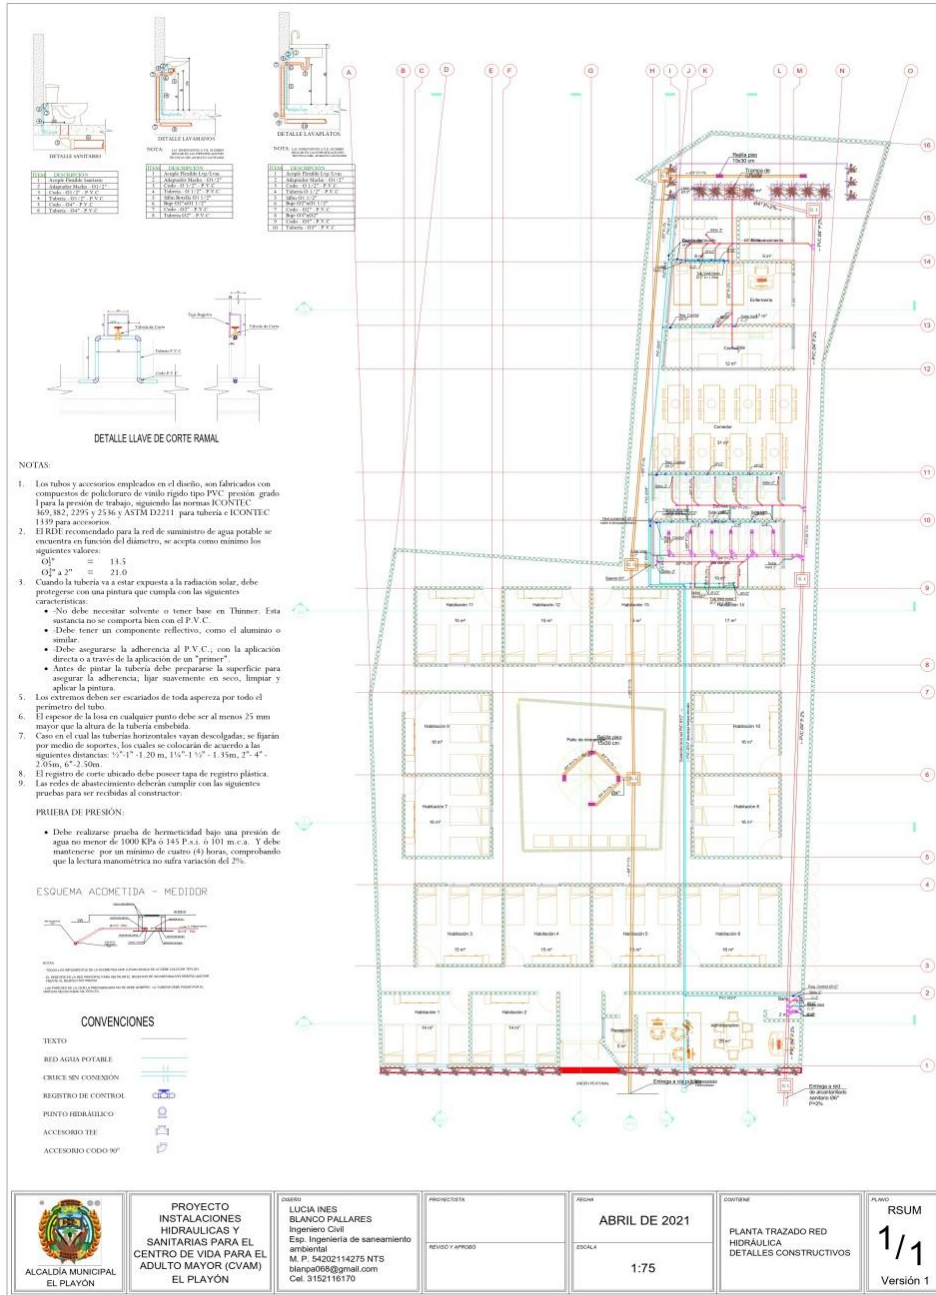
Planta Trazado Red Hidráulica, detalles constructivos
